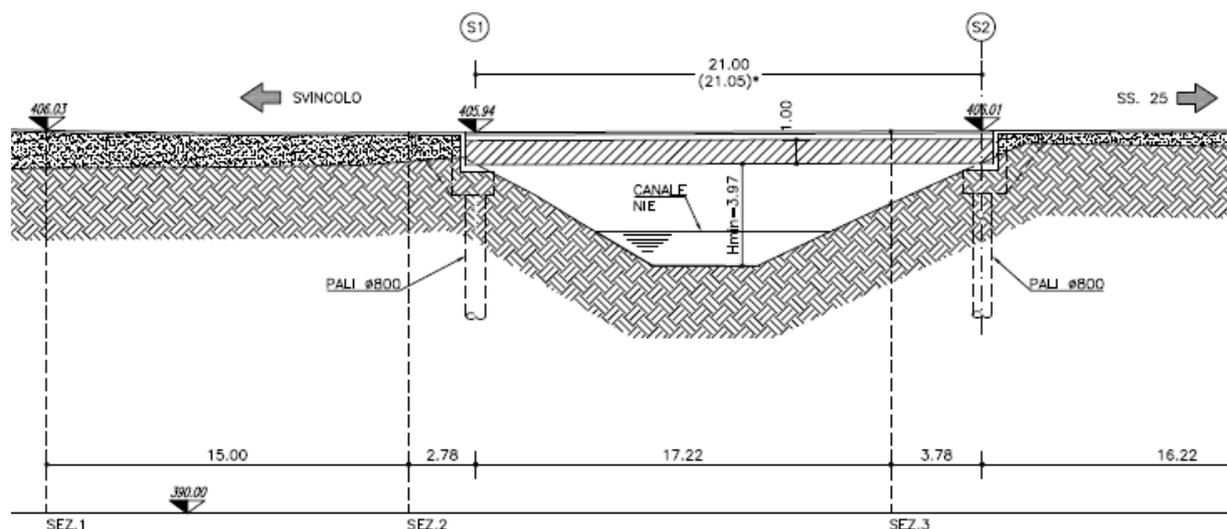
Profilo longitudinale del Ponte sul canale NIE
